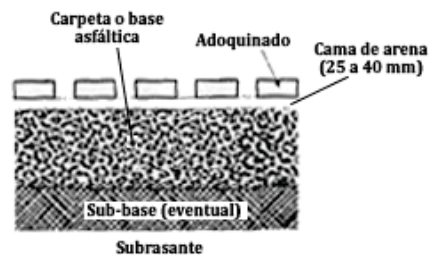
CAPA DE ADOQUINADO SOBRE PAVIMENTO ASFÁLTICO PRE-EXISTENTE
